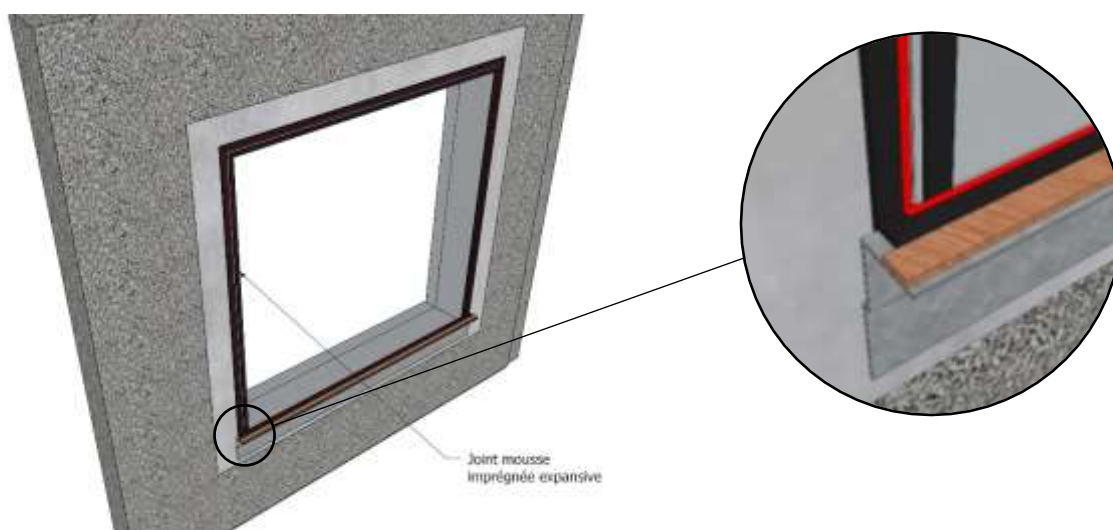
Pose de d'un joint mousse imprégnée expansive sur la face intérieure du précadre soudé étanche monobloc
